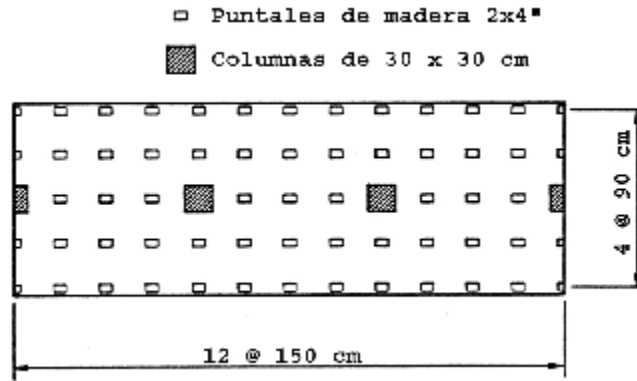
Planta característica del ejemplo usado en el modelo MME
